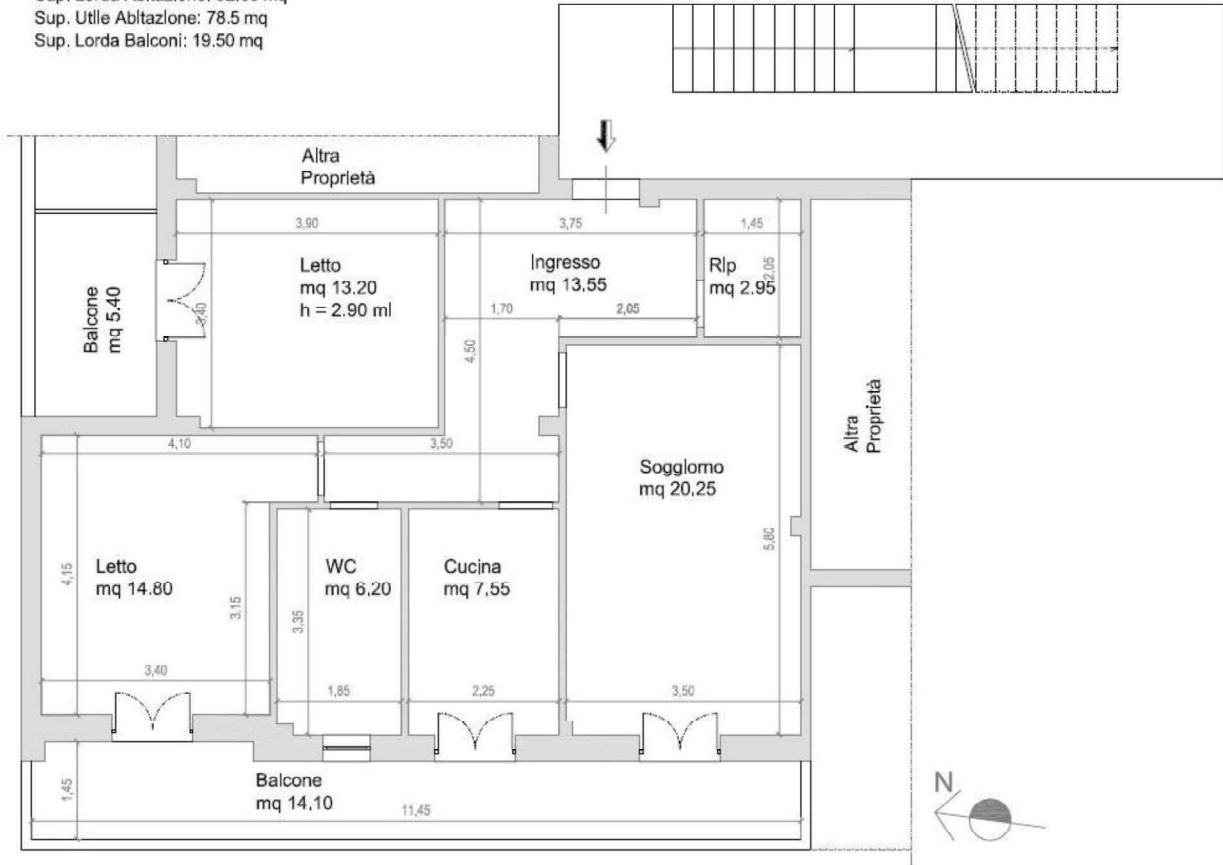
Planimetria Catastale Immobile Pignorato, Piano Terzo, Foglio 22, p.lla 267, Sub 20.
